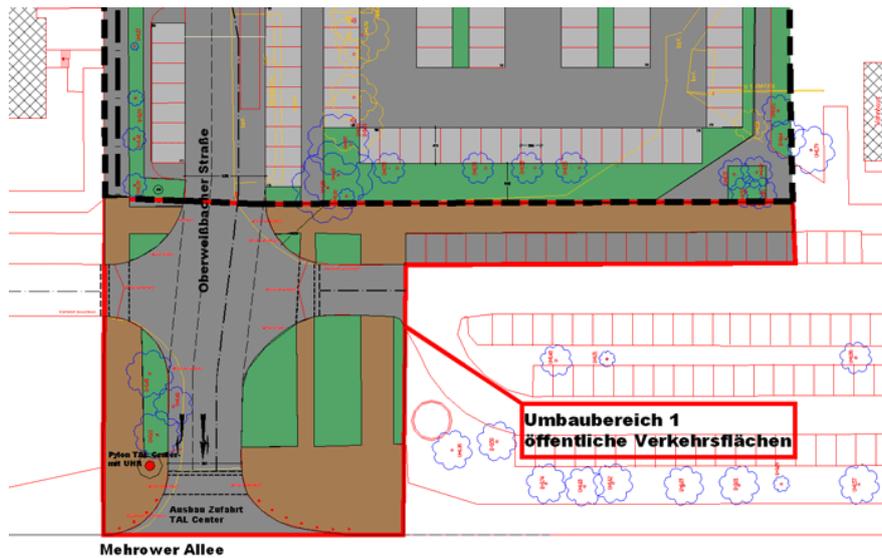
Ehemalige Planung Umbaubereich 1, öffentliche Verkehrsflächen, Stand Juni 2007
